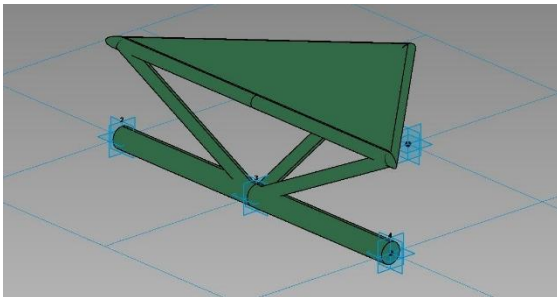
Detalle de Capitel de columna para soporte de cubierta.
